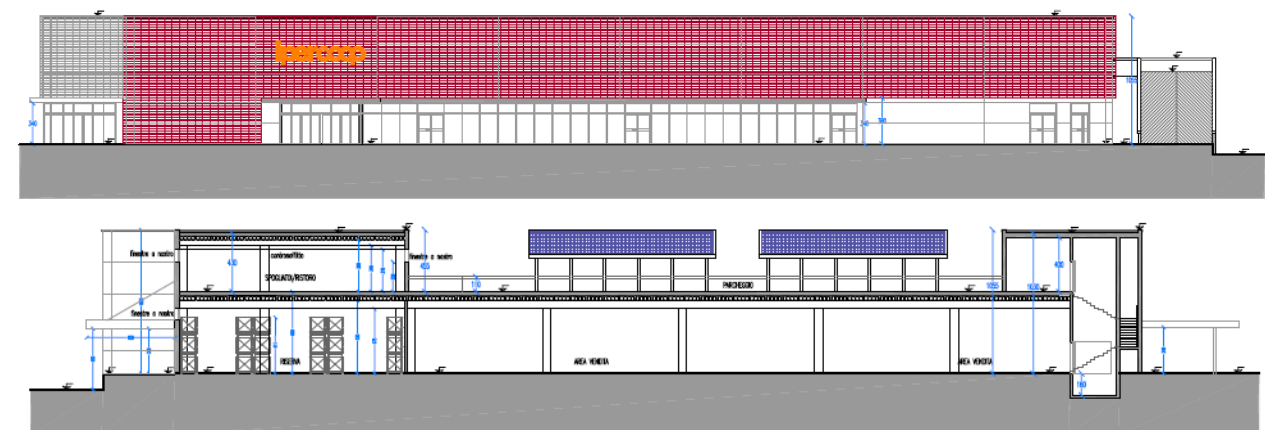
Prospetto (est) e sezione (est-ovest)
